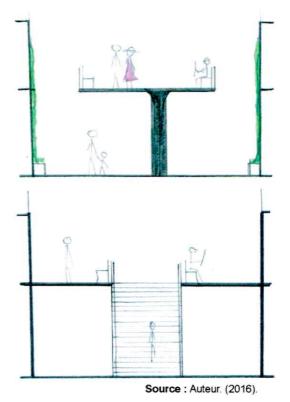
Esquisse de la vue en plan sur la passerelle.
